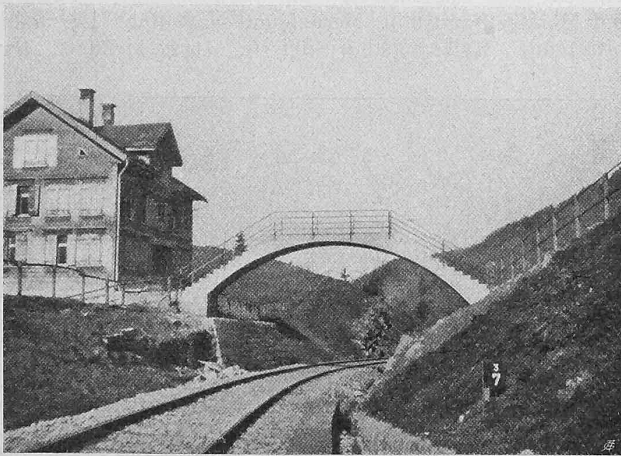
1,6 m breiter Fussgängersteg aus Stampfbeton bei Km. 3,7, 11 m Oeffnung, 30 cm Scheitelstärke, 16 m<sup>3</sup> Beton, Kosten 1300 Fr.
